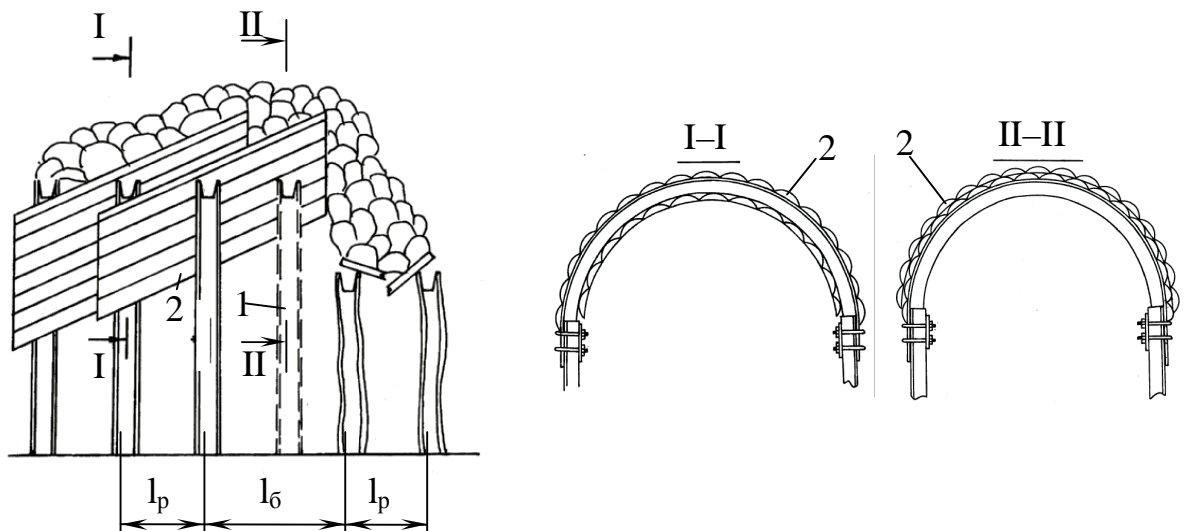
Схема установки дерев'яних кілків (шил) під час заміни аркового кріплення у виробці, що перекріплюється: 1 – установлювана рама аркового кріплення; 2 – дерев'яні кілки (шила)
